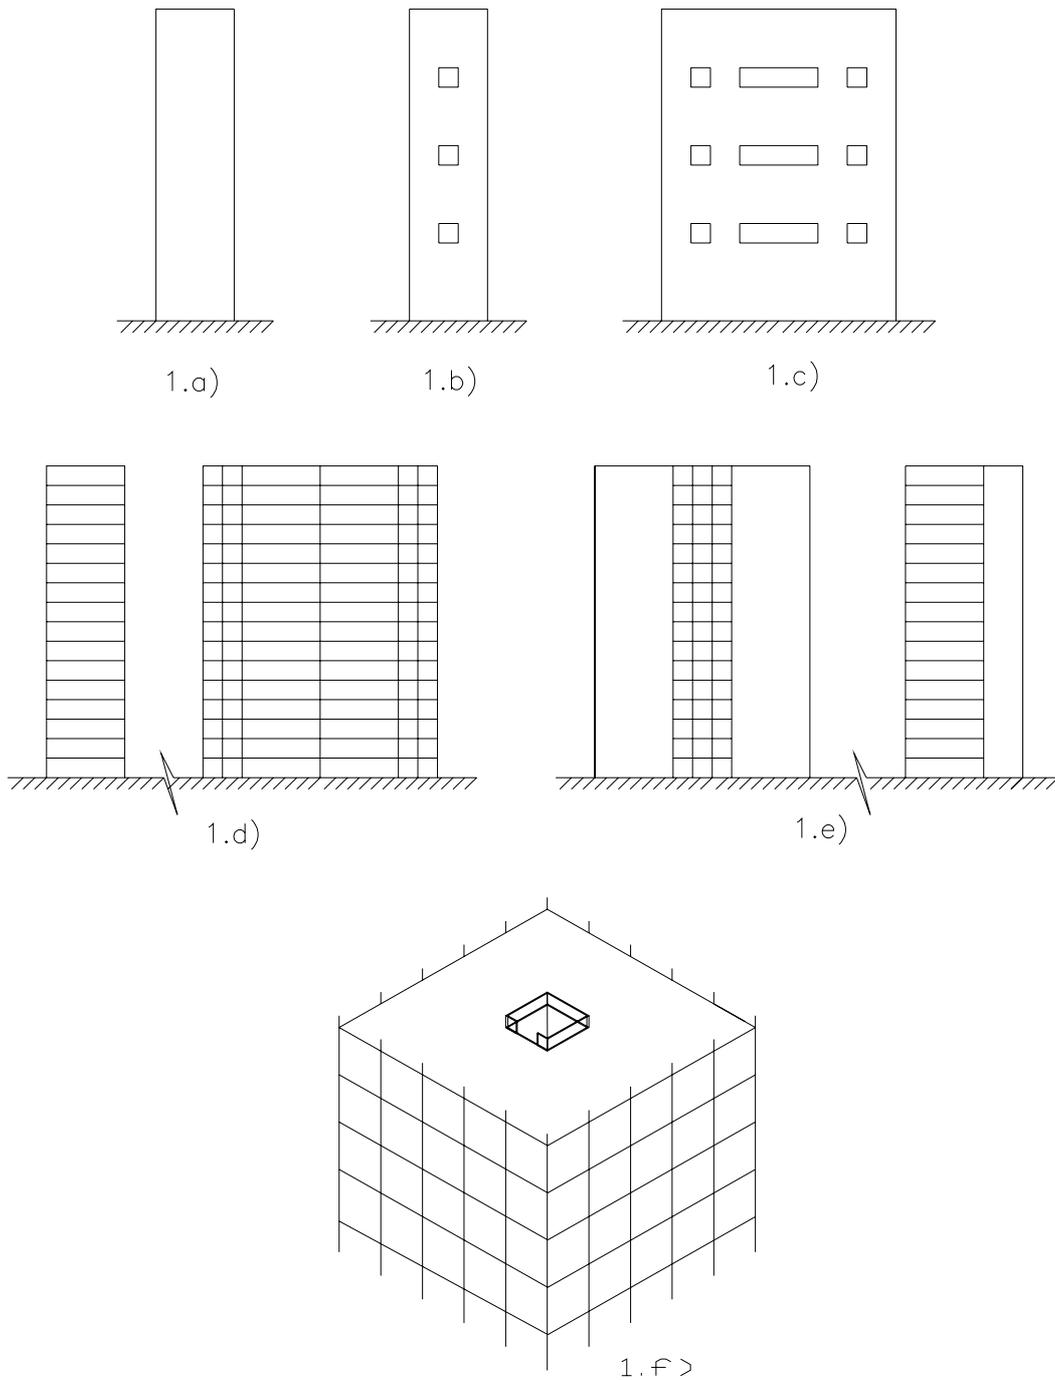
Tipos de contraventamento: a) Parede cheia ou cega; b) Idem mas com pequenas aberturas; c) Idem mas com uma ou várias fileiras de abertura; d) Pórticos, e) Paredes associadas a pórticos; f) Núcleo
